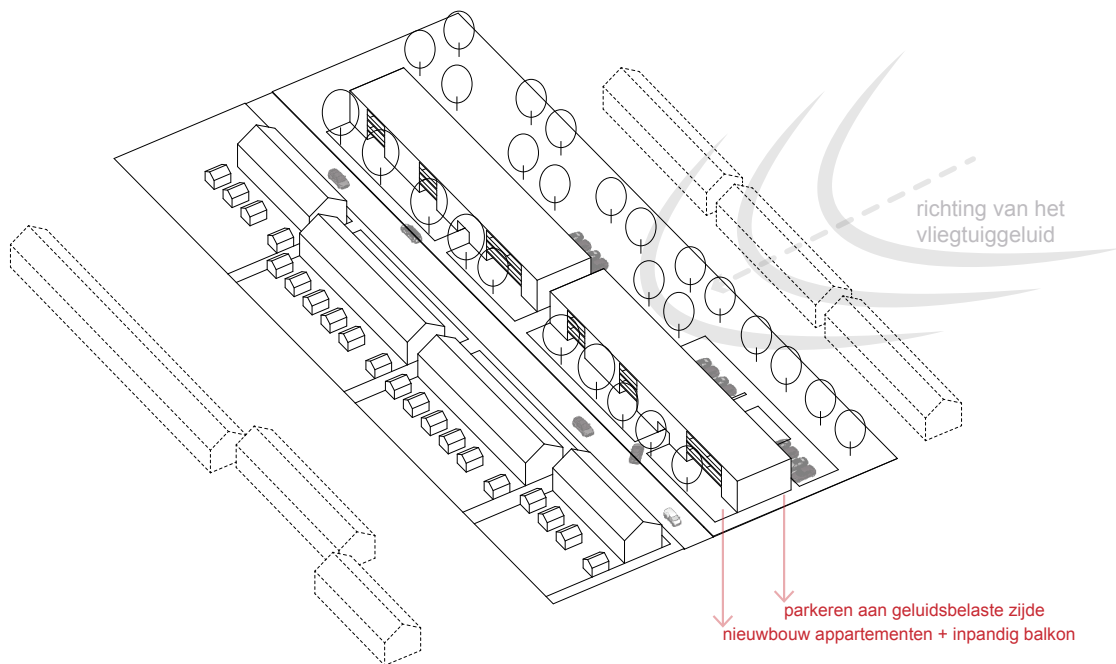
Ruimtelijke uitwerking en ingrepen voor variant 2, voorbeeld met een fietsstraat en extra groenstrook.
